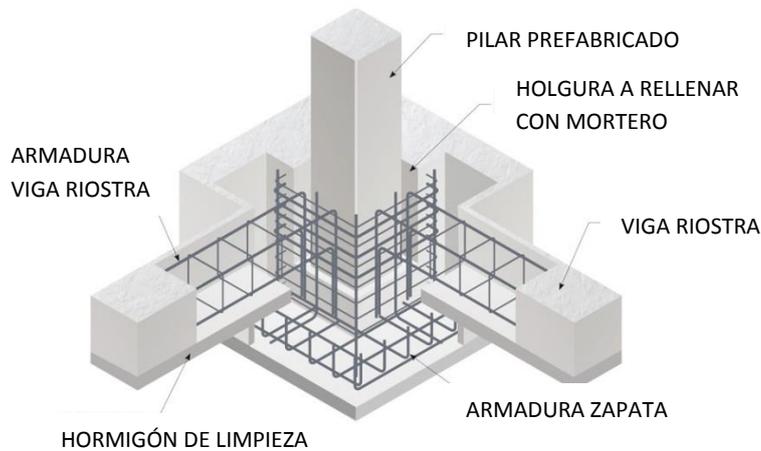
Unión de zapata, pila prefabricado y viga riostra.
